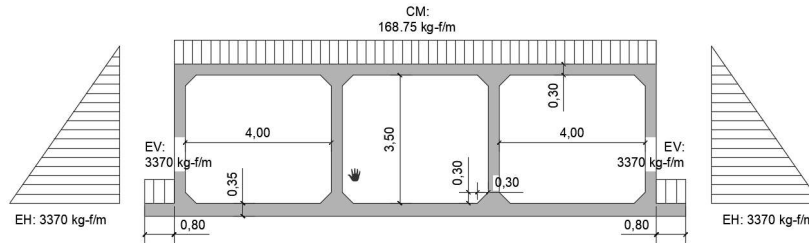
Análisis de cargas de la estructura marco de concreto armado. Fuente: Elaboración propia
